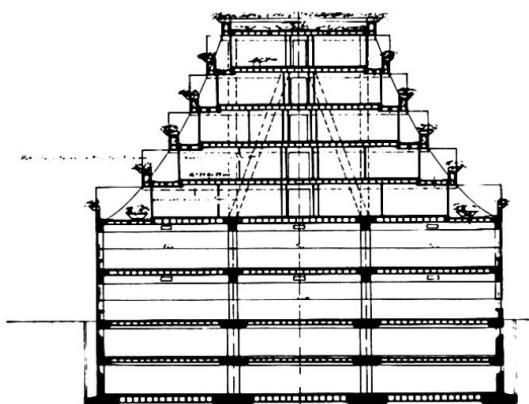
Steilwandiges Gebäude mit oberem Terrassen- aufbau.
